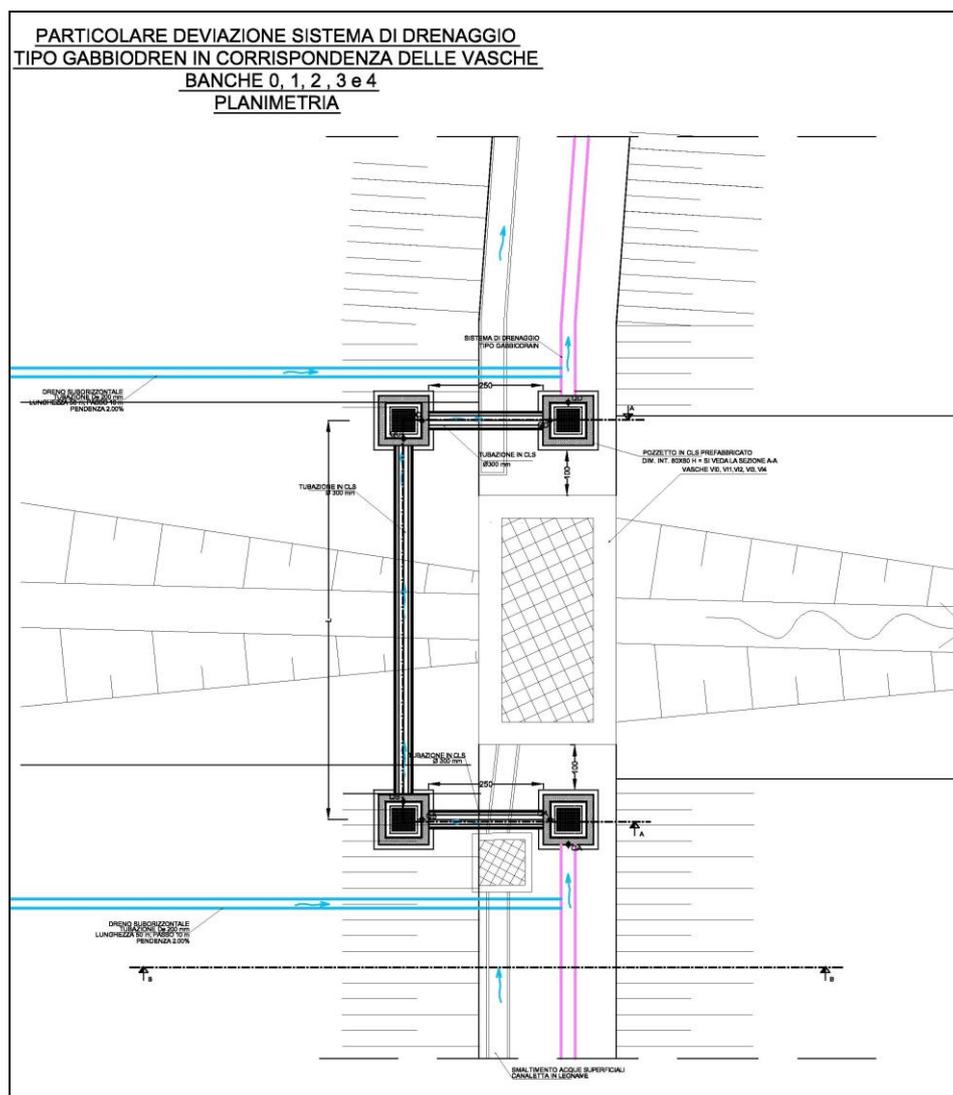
Particolare deviazione del sistema tipo Gabbiodren in corrispondenza delle vasche lungo il compluvio centrale
